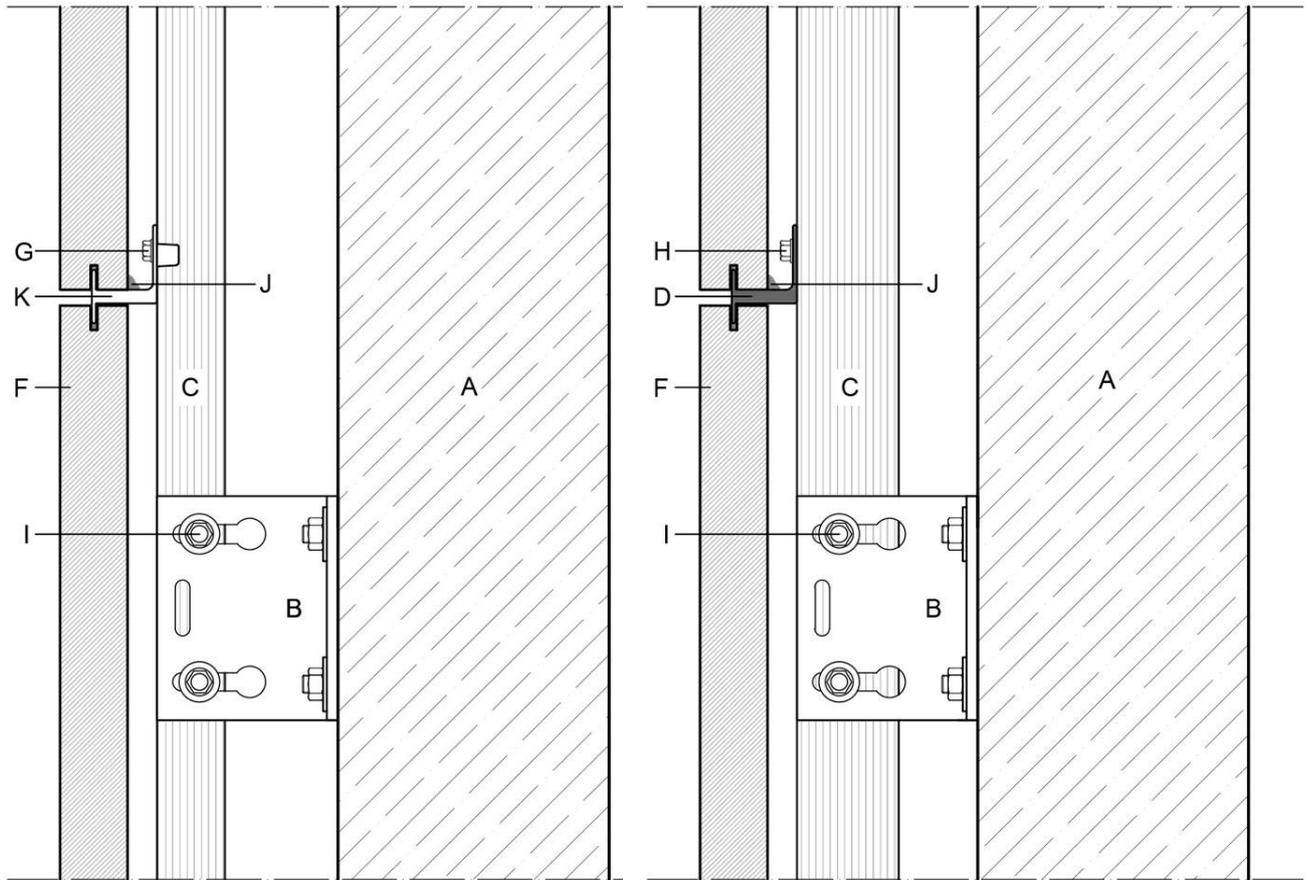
DETALLE DEL SISTEMA DE SUBESTRUCTURA Y FIJACIONES – SECCIÓN HORIZONTAL
